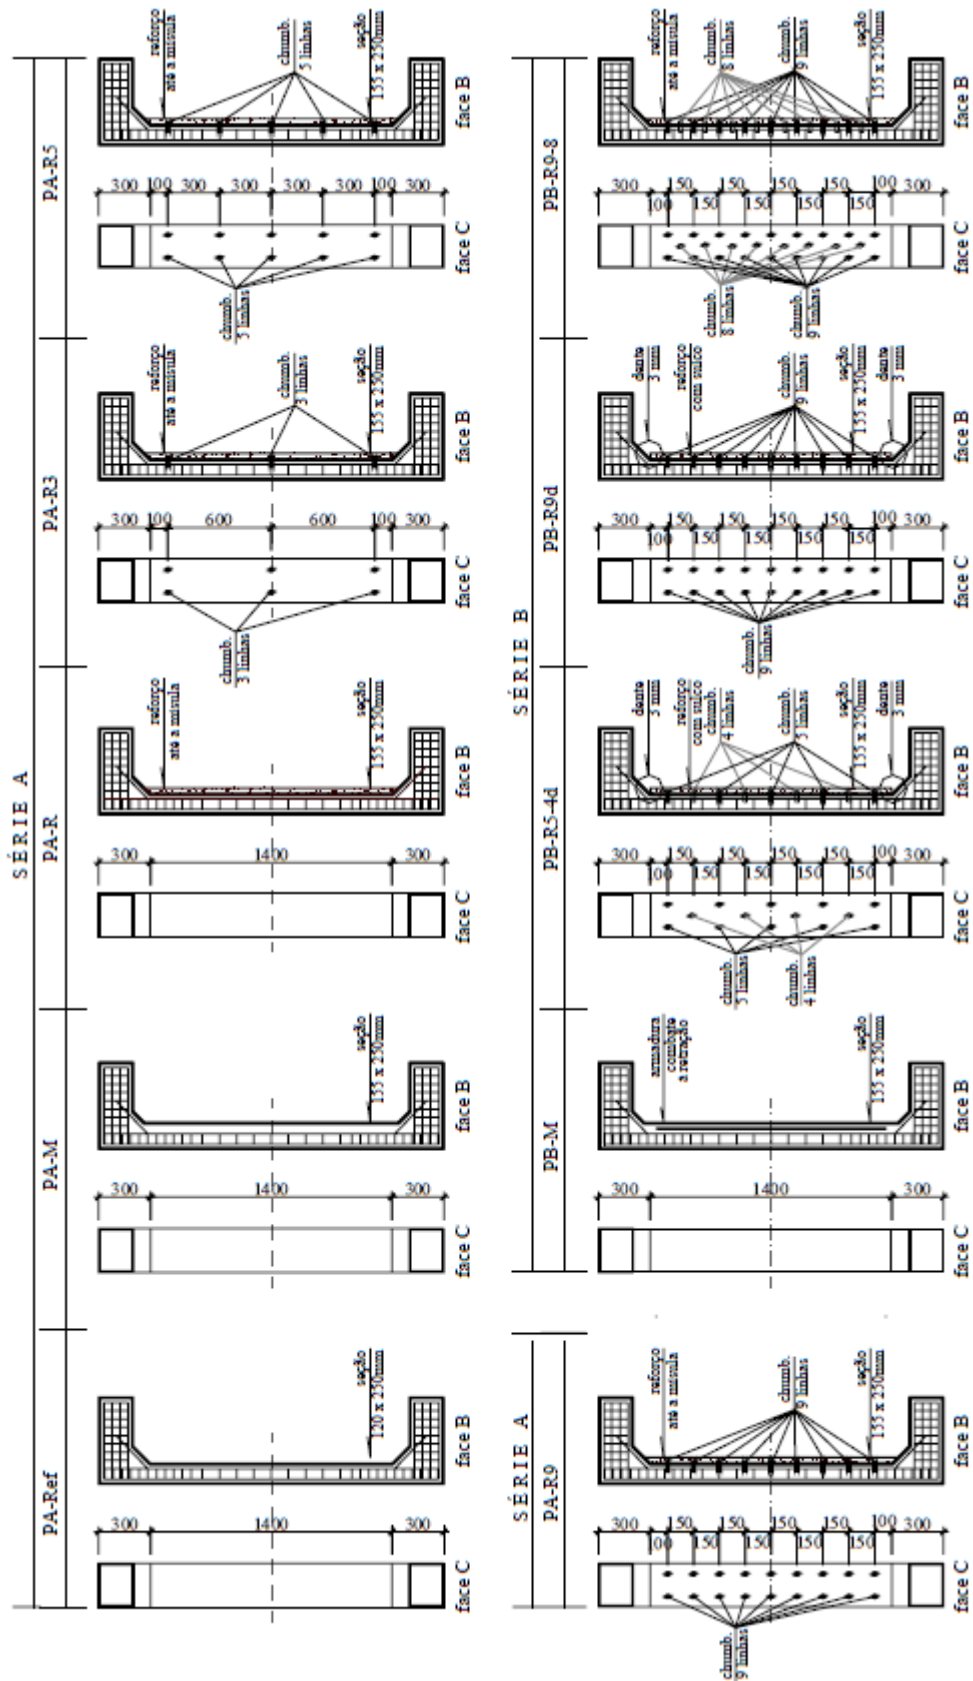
Planta com disposição de chumbadores dos pilares (SAHB, 2008)
